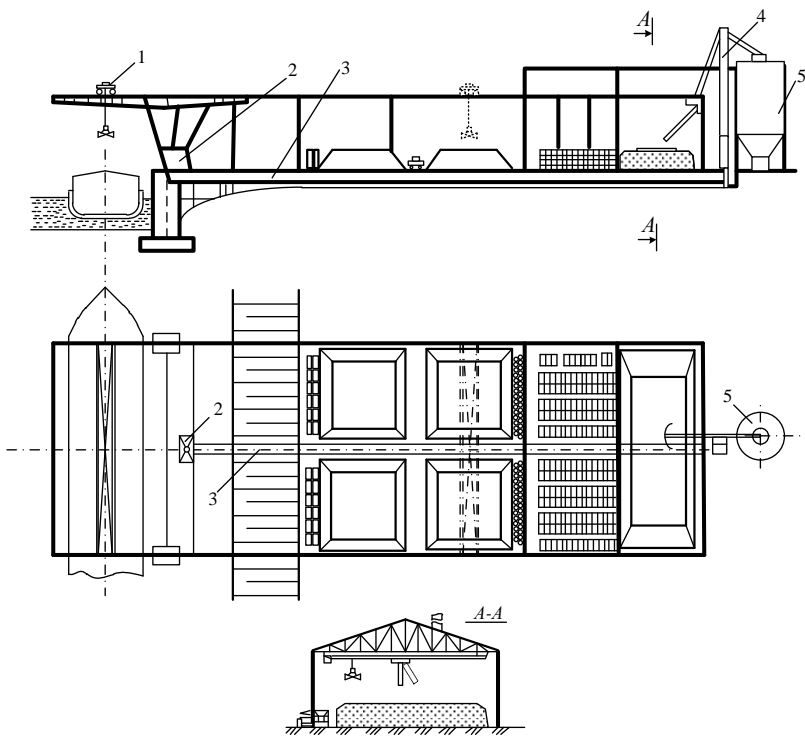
Схема механизации с мостовыми кранами на однопролетной эстакаде для выгрузки из судов насыпных и штучных грузов открытого и крытого хранения
